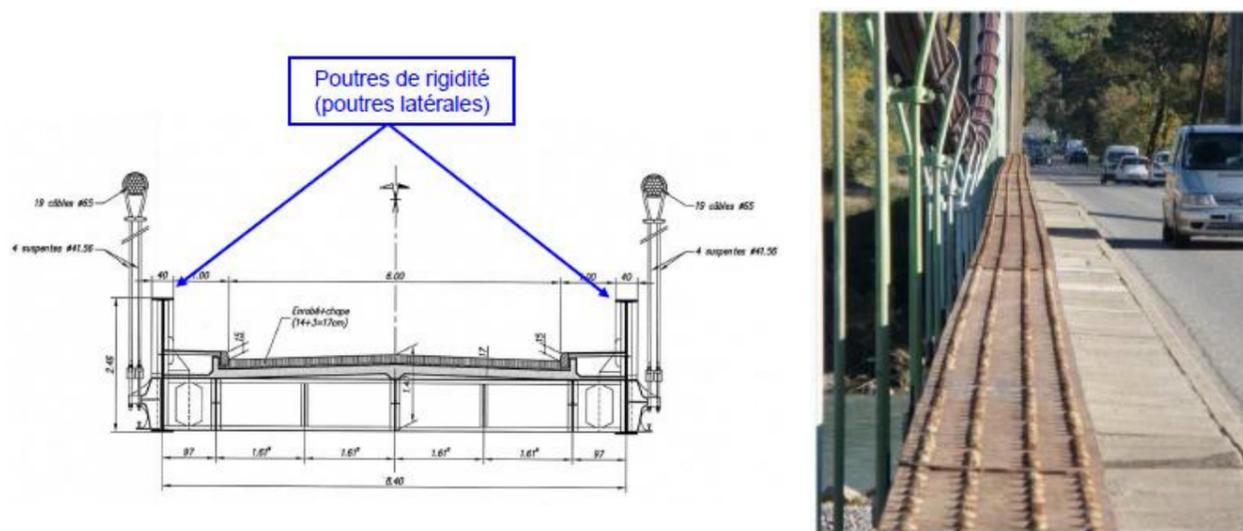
Schéma et illustration des poutres de rigidité (Source : CD04)
